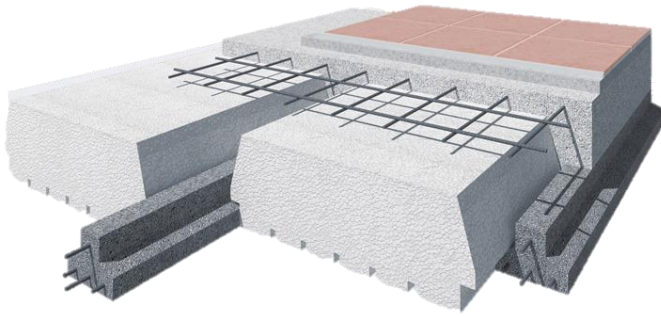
Esquema ilustrativo de losas de viguetas pretensadas
